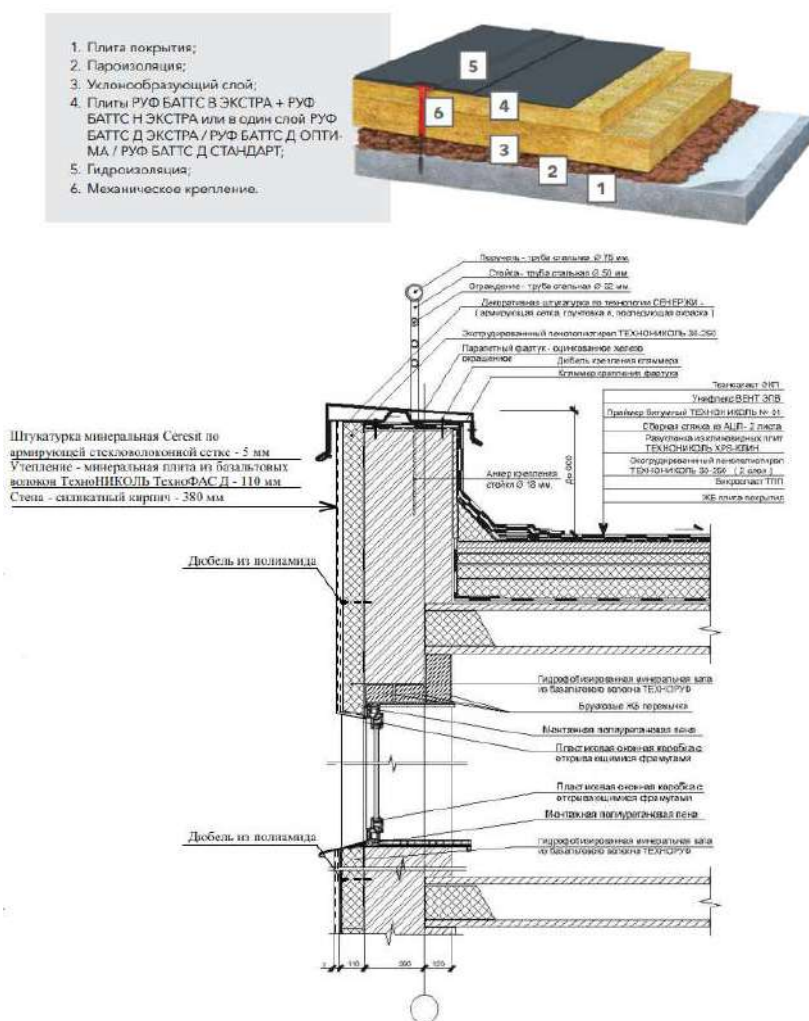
Состав плоской кровли по железобетонному основанию
